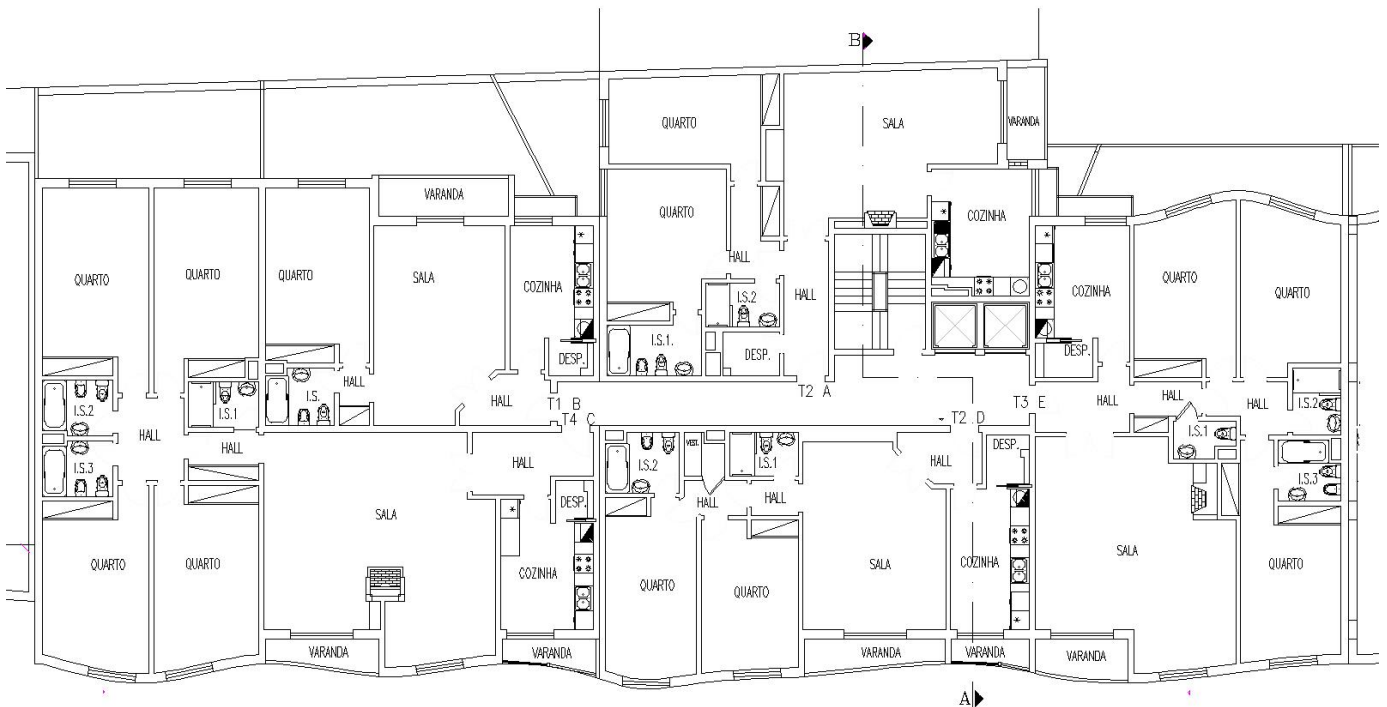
Planta da arquitetura tipo do caso de estudo 1.
